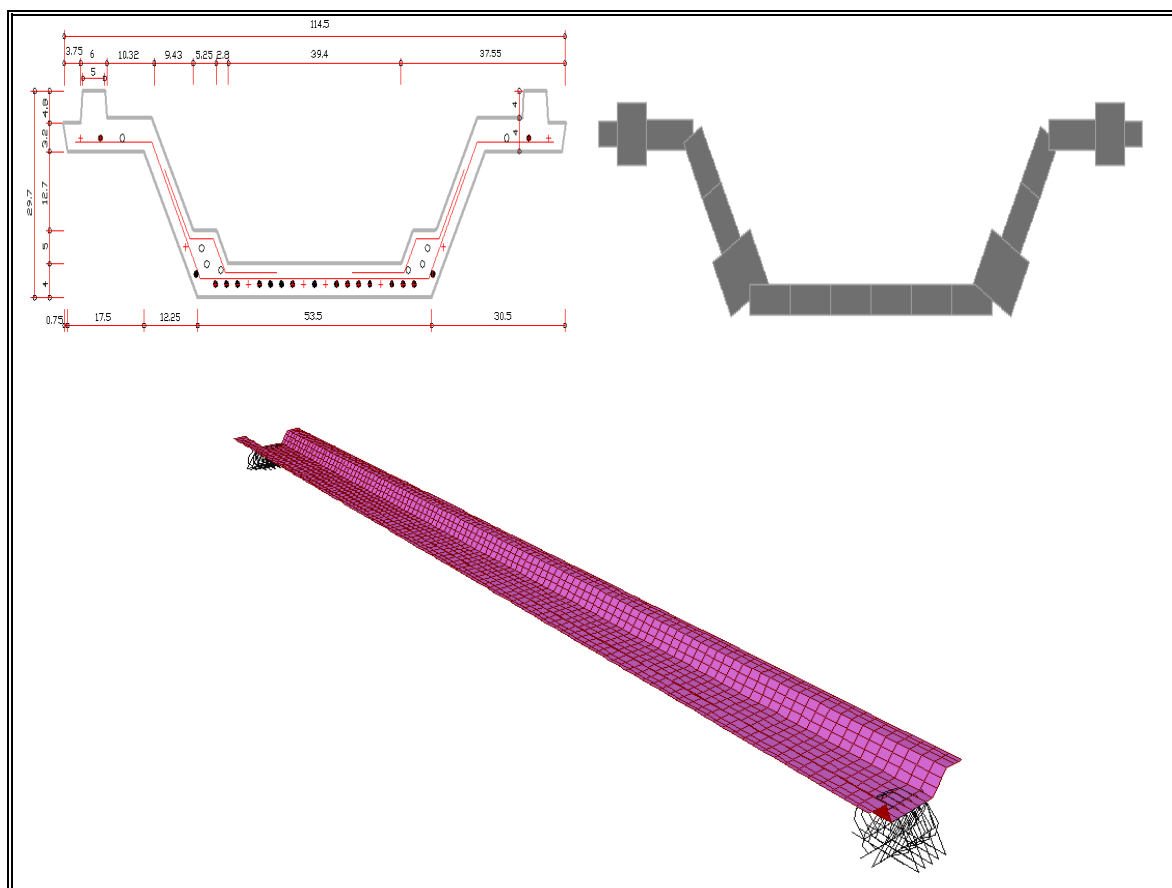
Sección transversal del canalón Dalla y su representación con elementos finitos (arriba) y vista general del modelo numérico.
